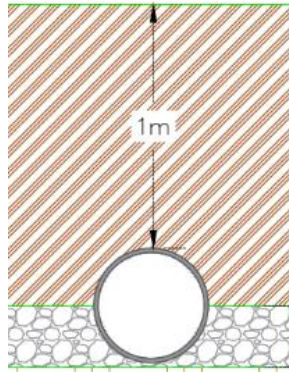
cota clave de la tubería; Fuente: (Carreño, 2023)
